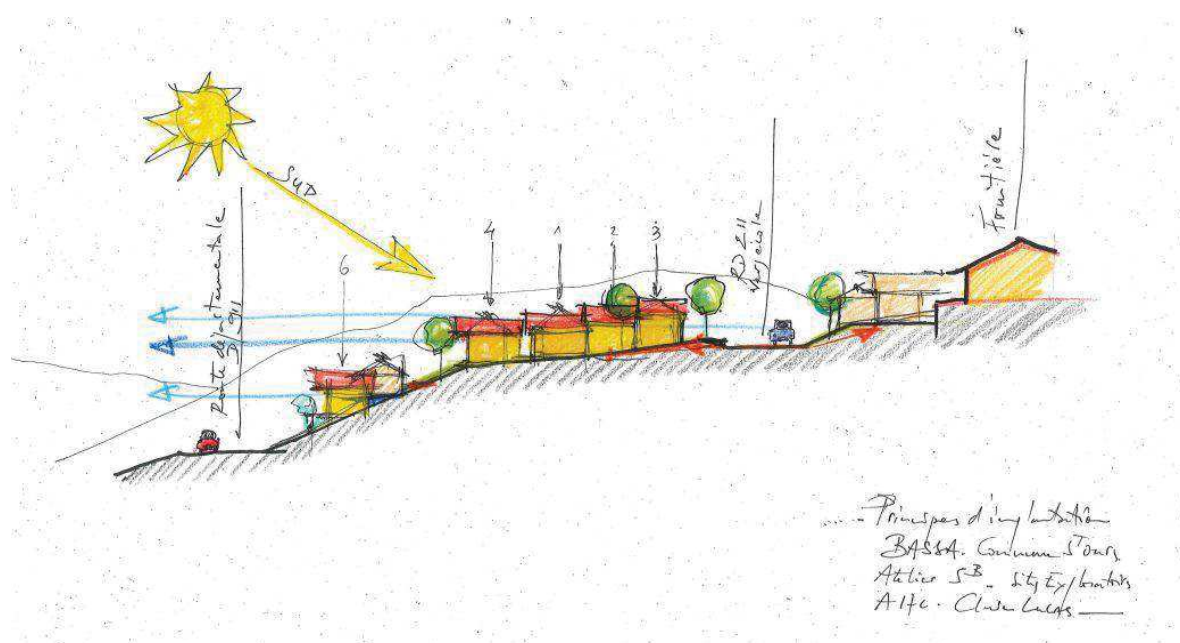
Projet en coupe sur Bassa. CR Atelier "activation".
